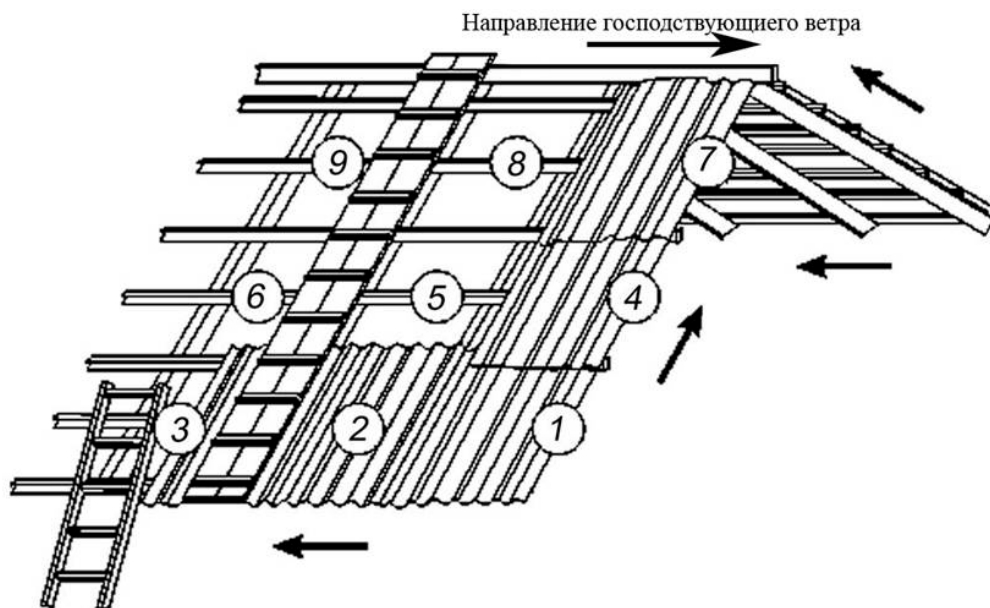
Схема укладки хризотилцементных листов по двухпролетной схеме
